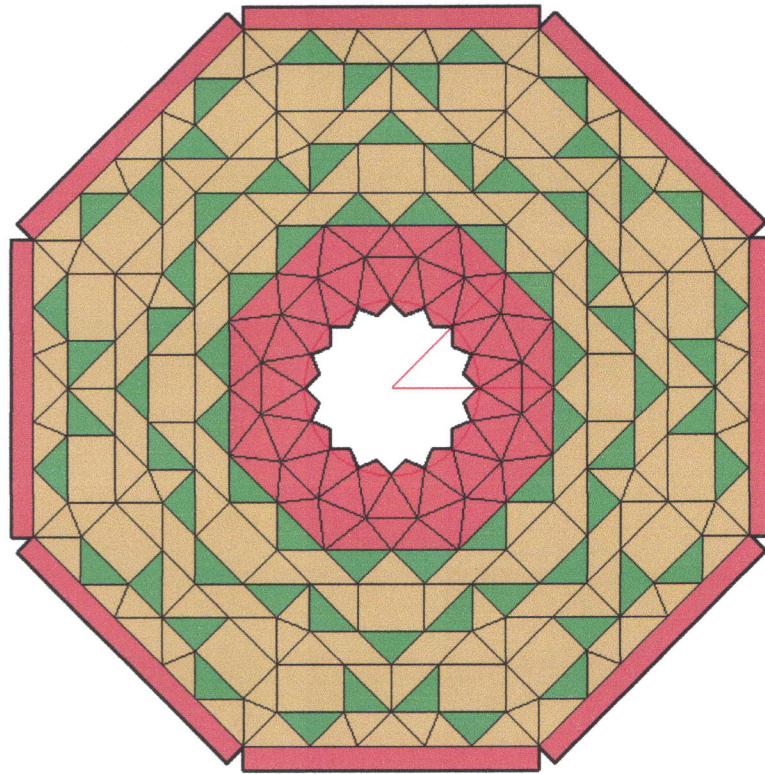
ape 03 du montage des pièces de Mouqarnas projection et 3d dessiné par l'auteur
